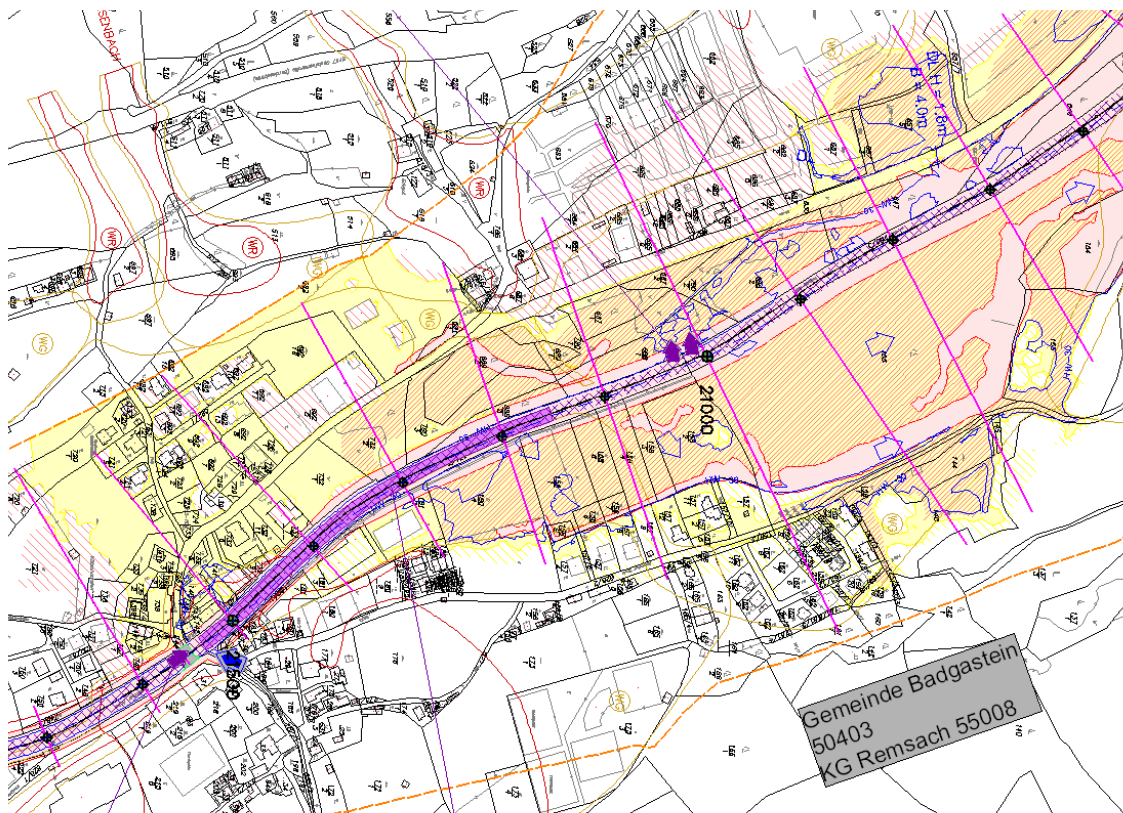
Lageplanausschnitt Kötschachdorf Gemeinde Bad Gastein
